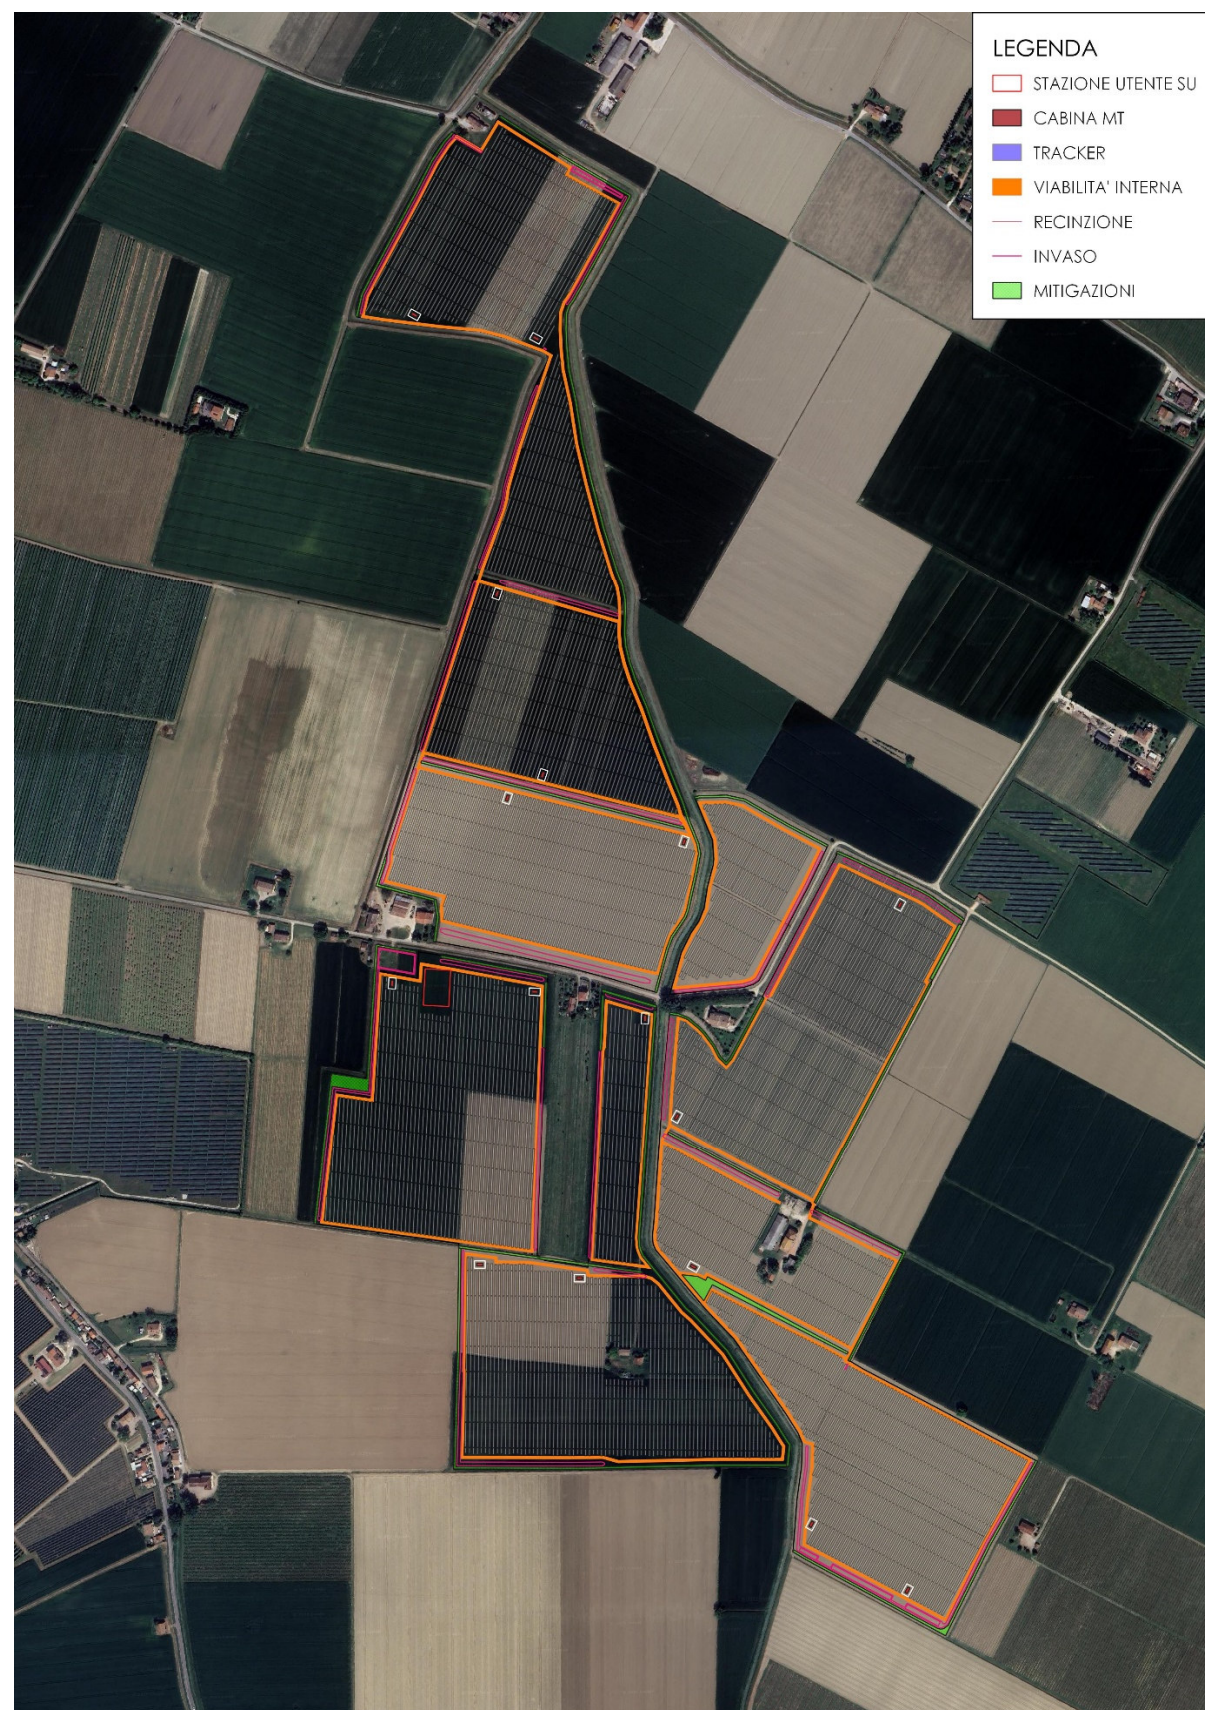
Planimetria di cantiere; in arancio la viabilità di cantiere, mantenuta anche in fase di esercizio dell'impianto a fini manutentivi.
